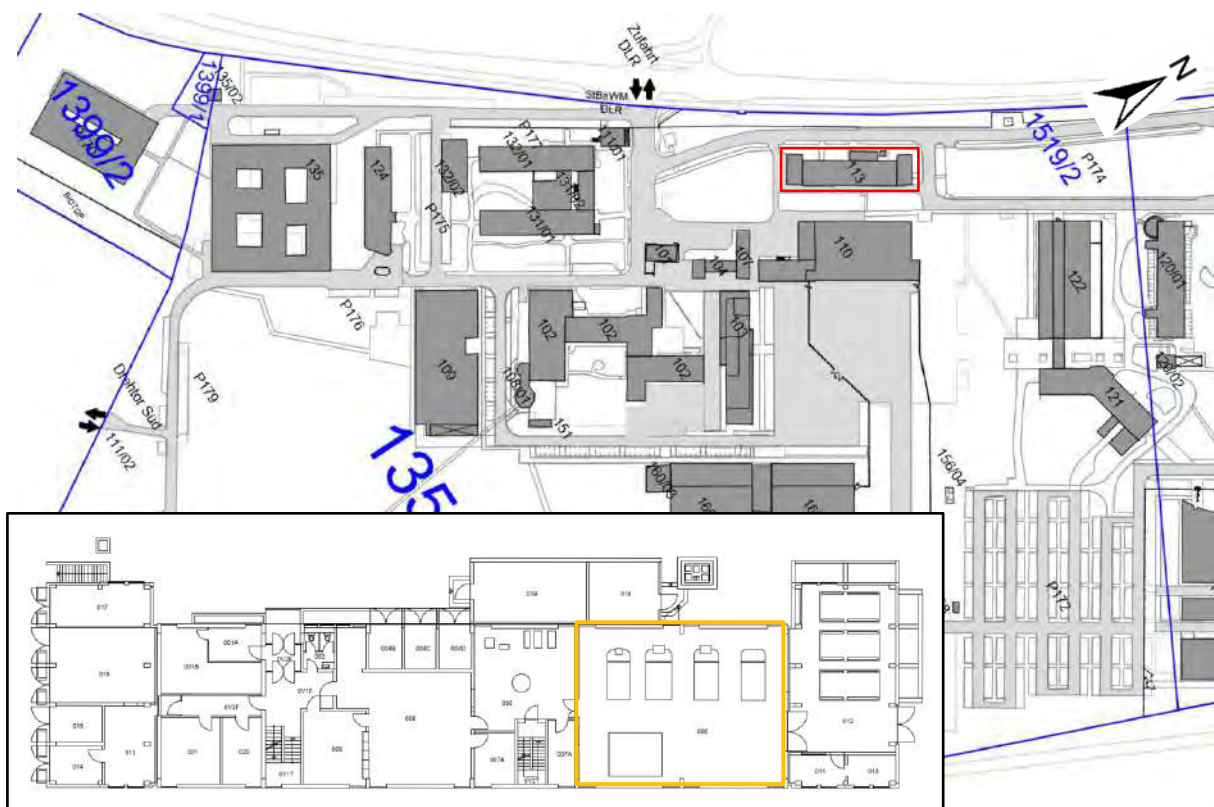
Lage von Gebäude 113 (rot). Ausschnitt aus [6]. Im EG-Grundriss Lage des Heizraums als orangene Markierung [23].
